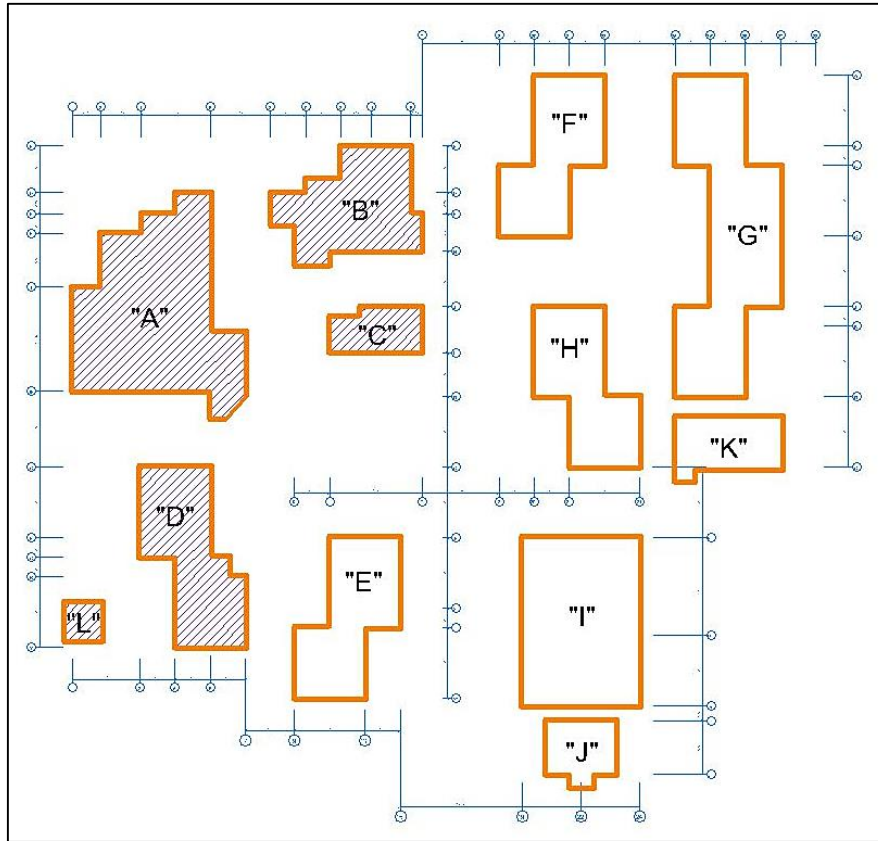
Vista en planta de la Distribución de la materia de estudio. Bloque II
